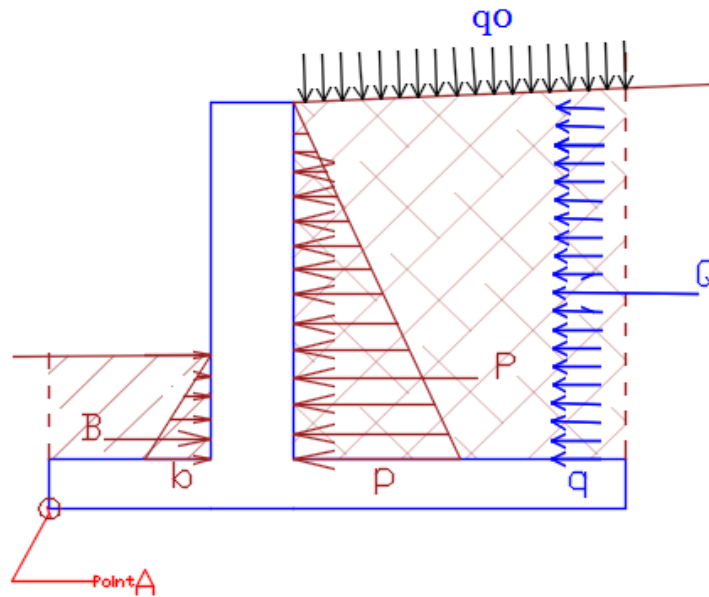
EFFORTS APPLIQUES SUR UN MUR DE SOUTÈNEMENT
